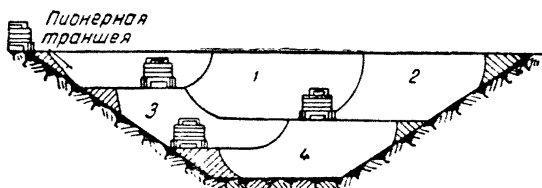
Схема разработки пионерной траншеи с погрузкой грунта в транспортные средства
